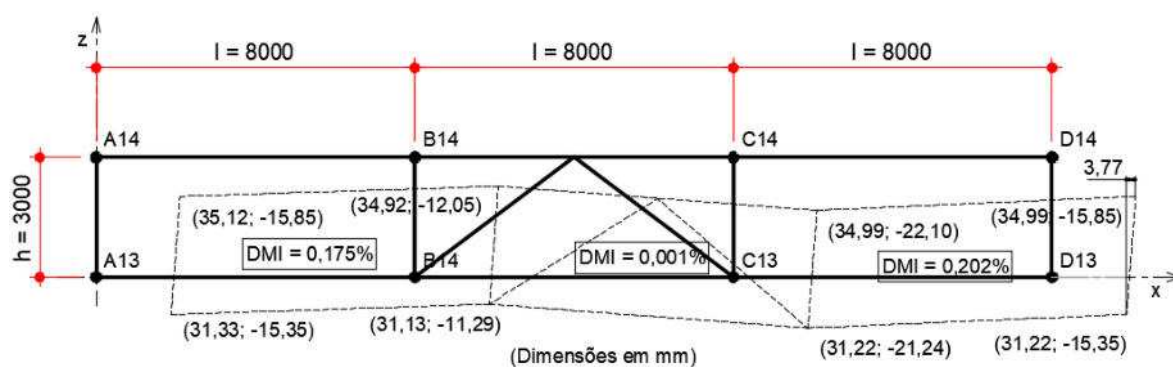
Modelo PCV-16 do 12º ao 16º pavimento, com pilares alterados
